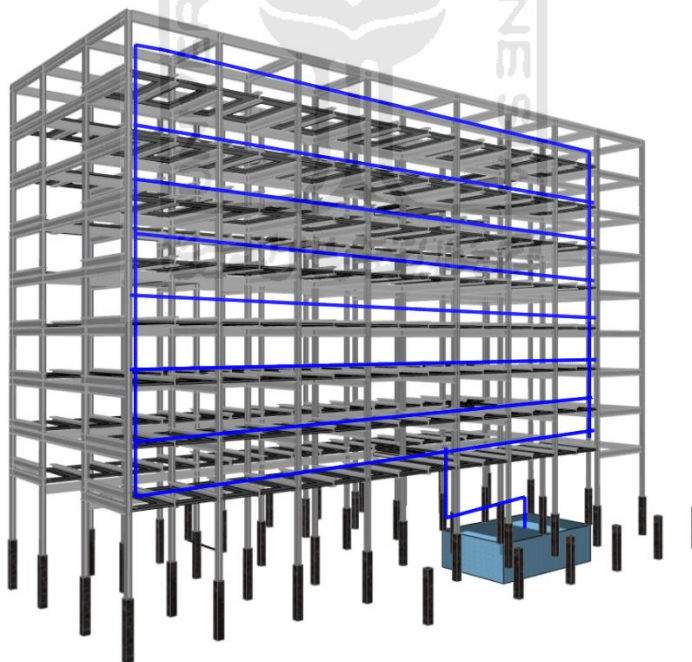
detail fasad vertical garden (sumber: analisa penulis)
